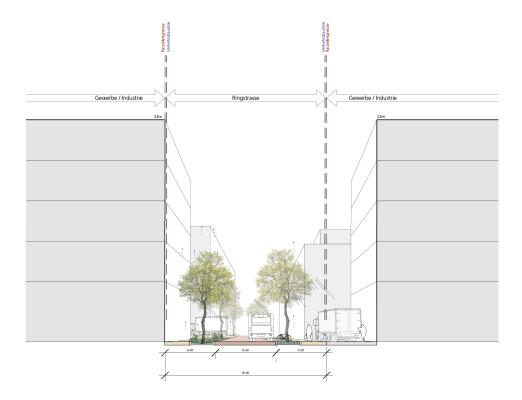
Schnitt durch die Ringstrasse (Quelle: Eckhaus Städtebau und Raumplanung; verändert durch Raum8vier)
